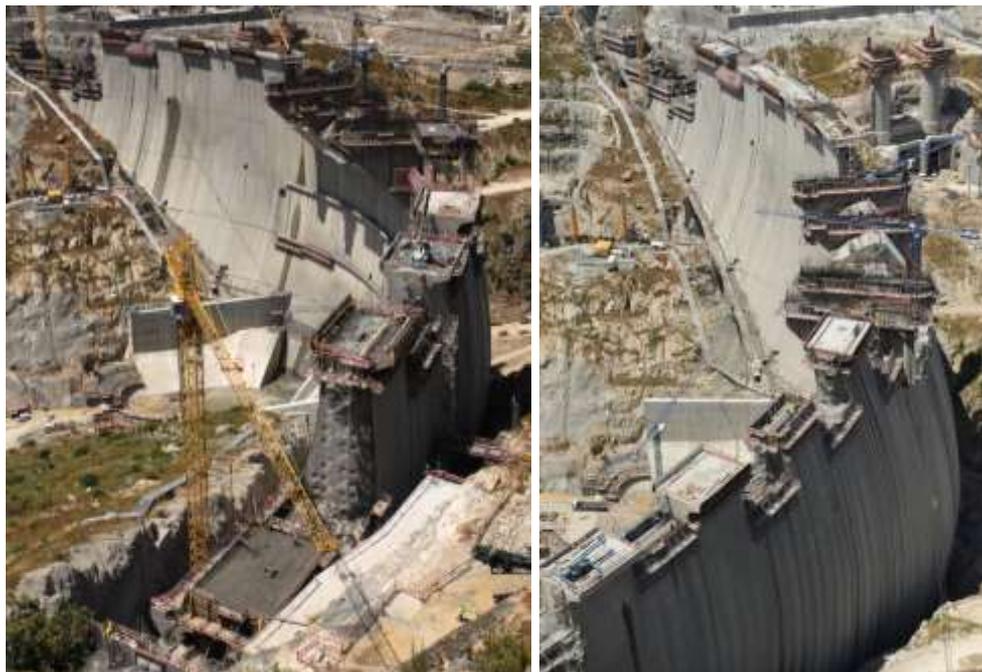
Fase intermédia Betonagem dos Blocos da Barragem
